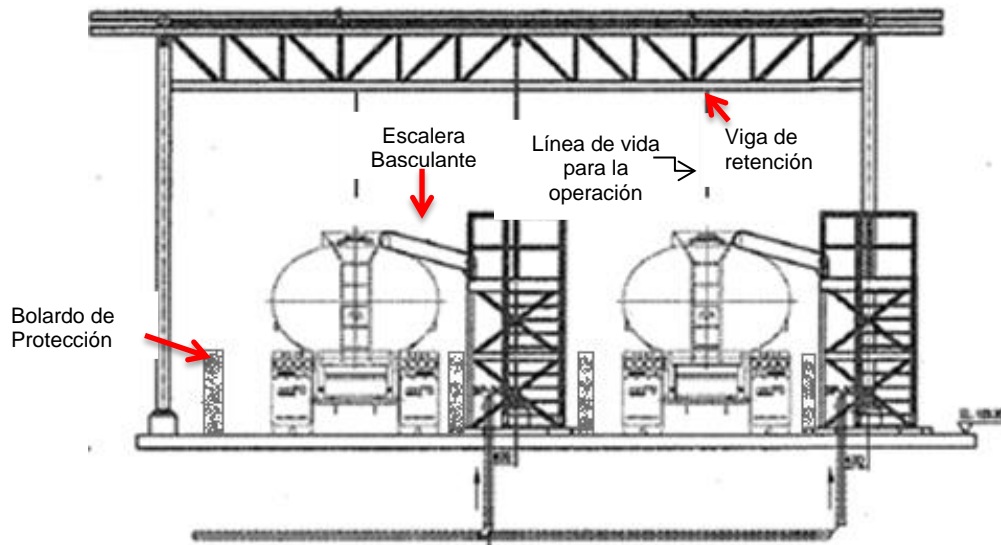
Infraestructura de islas de llenado – posicionamiento de carro tanques (Vista Longitudinal)¹⁸
